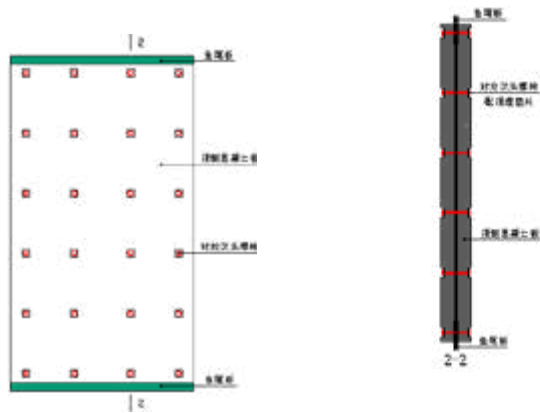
钢板与预制混凝土板拼装立面图 图3 钢板与预制混凝土板拼装剖面图
